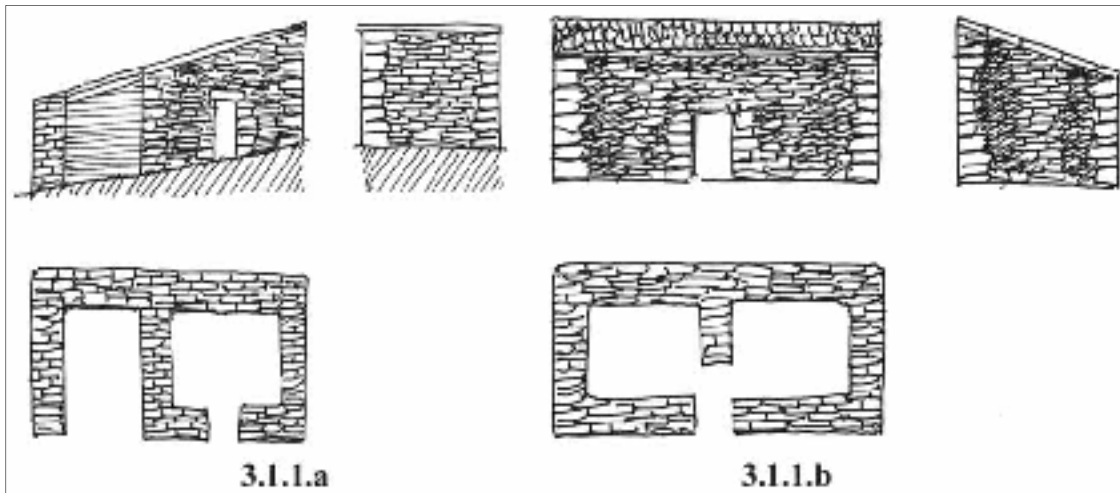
Construcciones de planta rectangular y techumbre a una sola agua.
